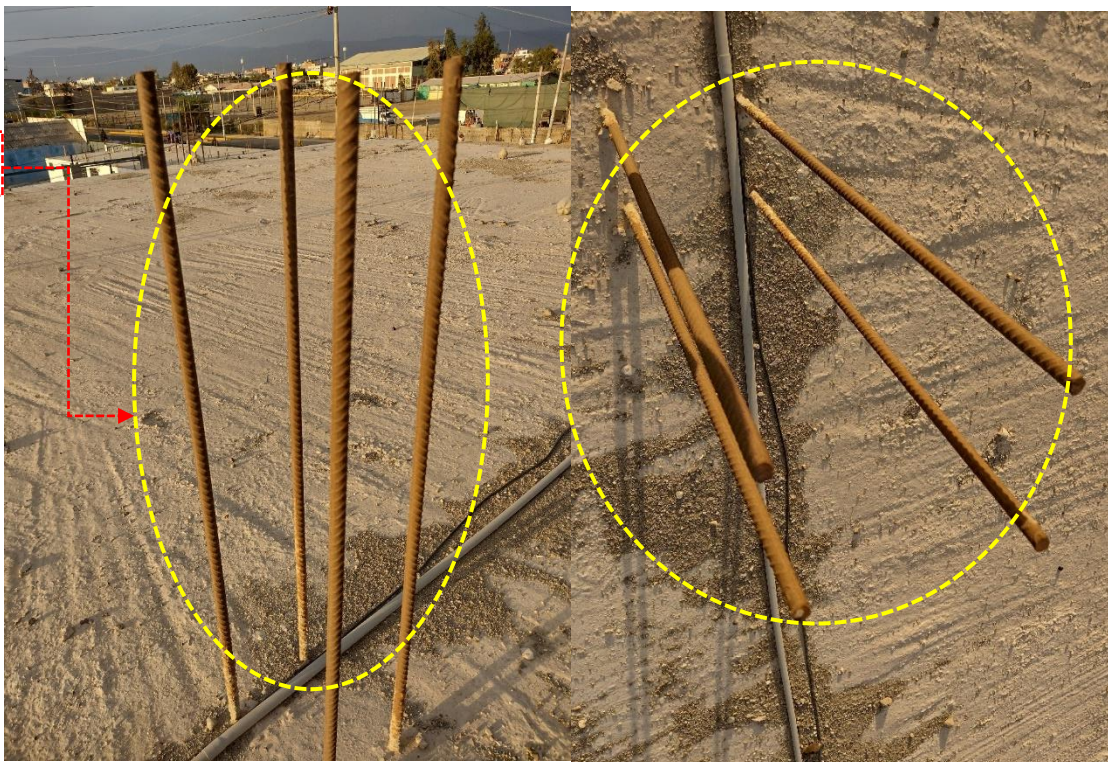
Arranque de acero interior en columna de pórtico Bloque 1
